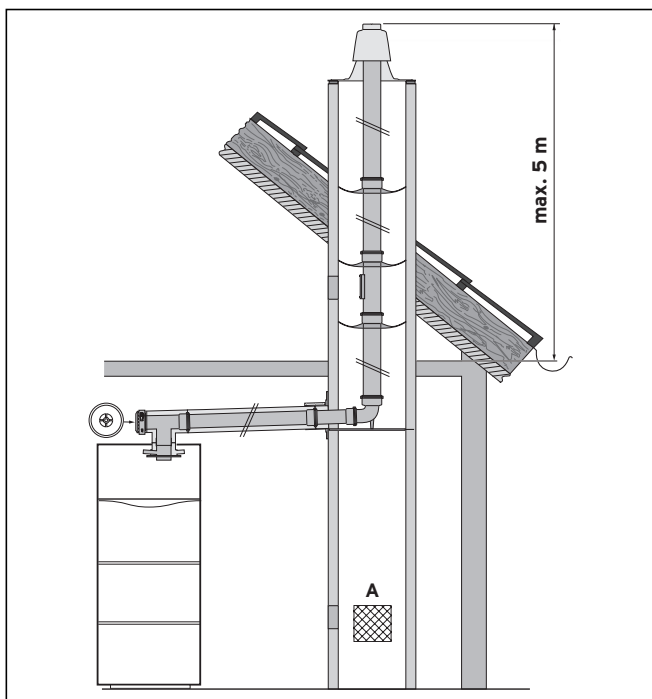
Пример монтажа с забором воздуха из помещения
